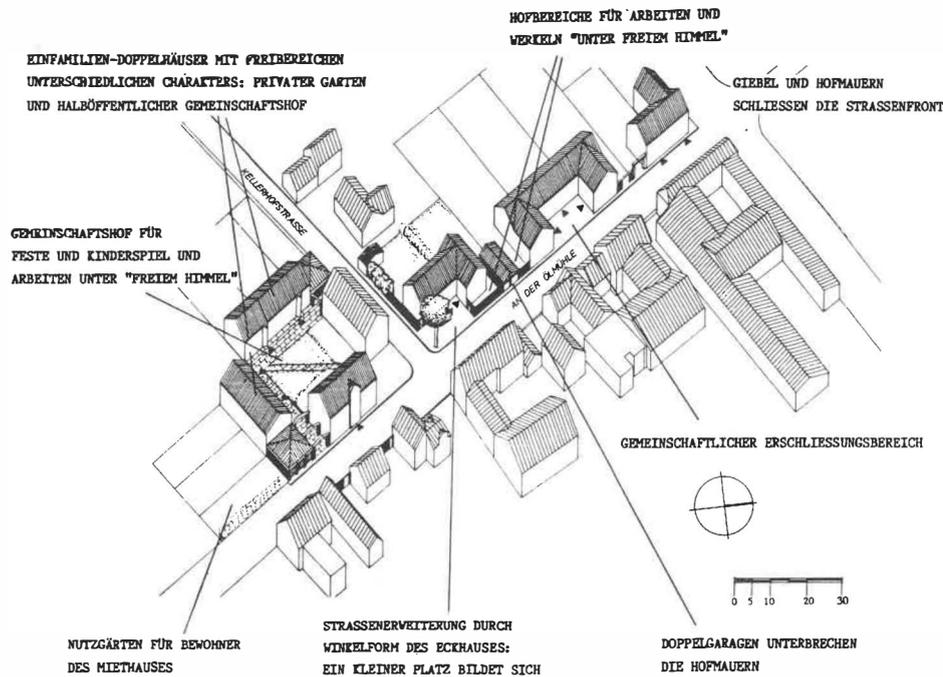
»Wohnhof Kellerhofstraße«, Lageplan
